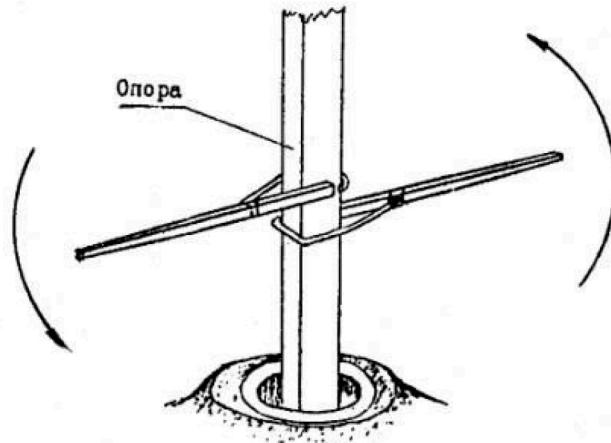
Кантование железобетонной опоры при помощи специальных приспособлений
